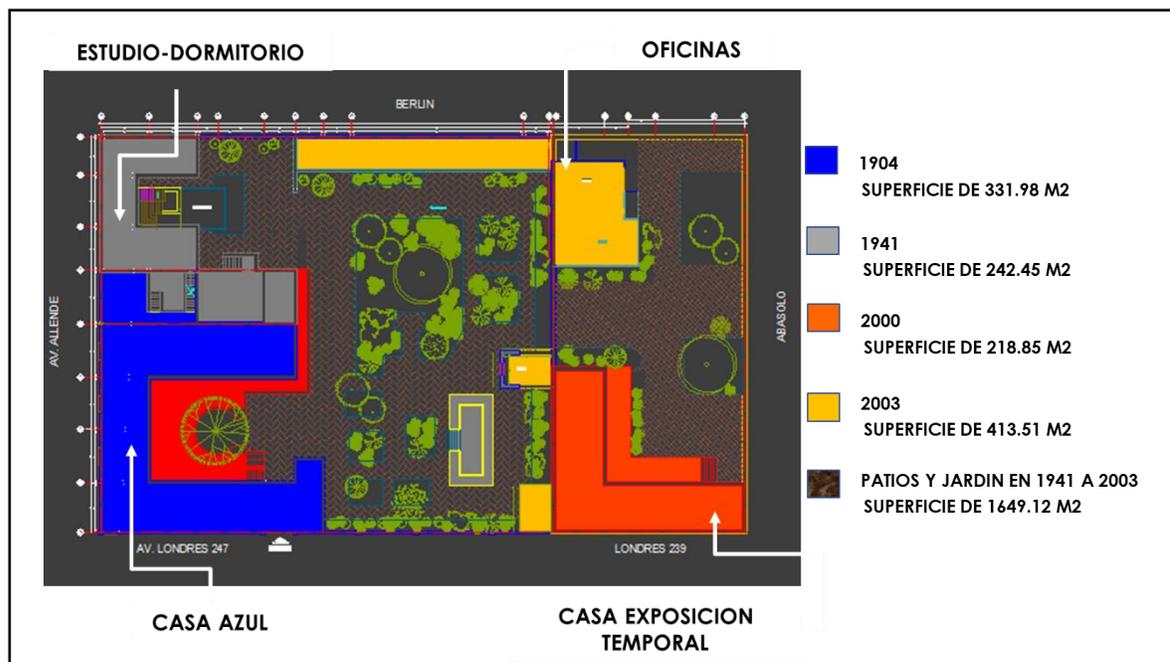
Croquis en planta Representativo de las etapas de construcción, Museo Frida Kahlo, México 2019
